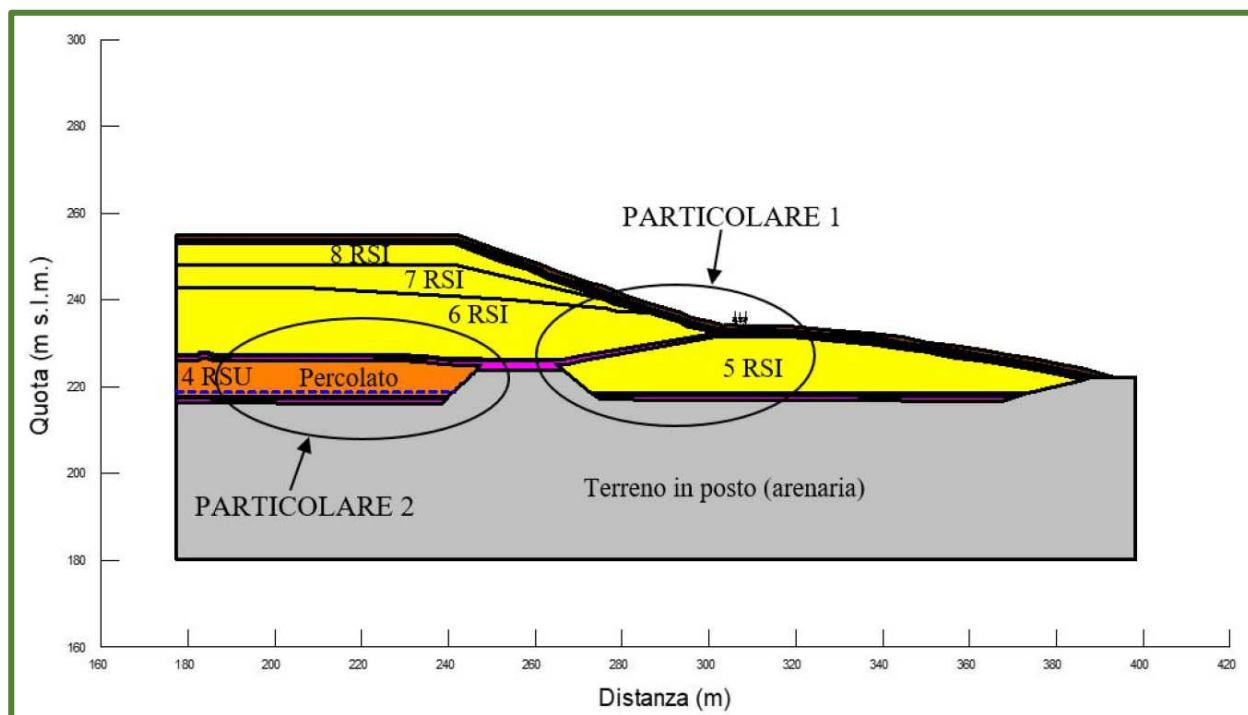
/IV – Sezione A-A' – Sponda sud-ovest
